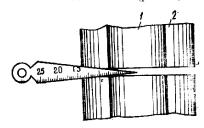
Измерение величины стыкового зазора клином. I – головка рельса; 2 – подошва рельса.
